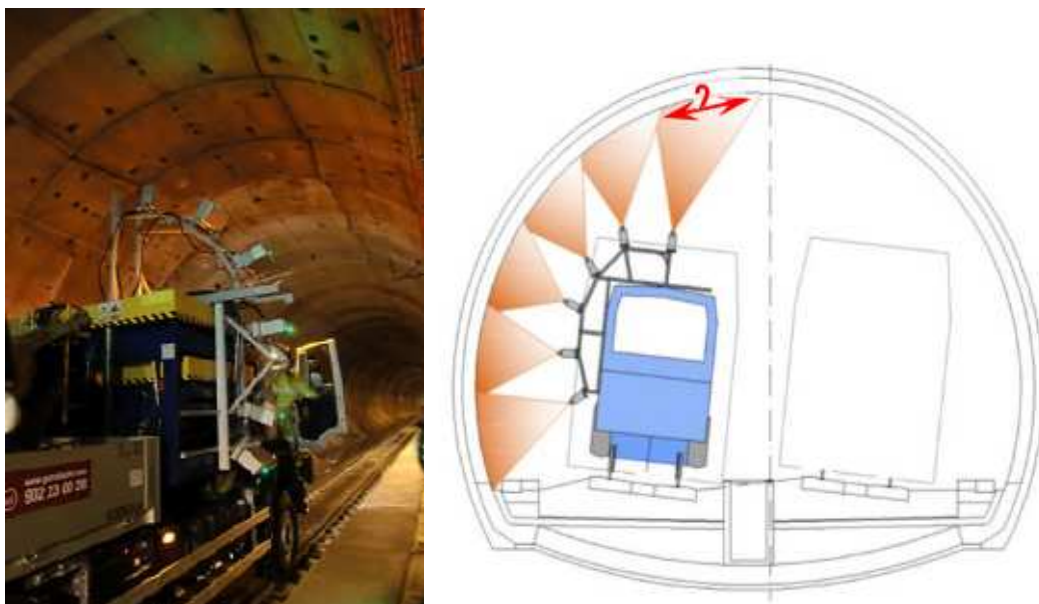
Sistema de escaneado de túneles LTSS de Pavemetrics
